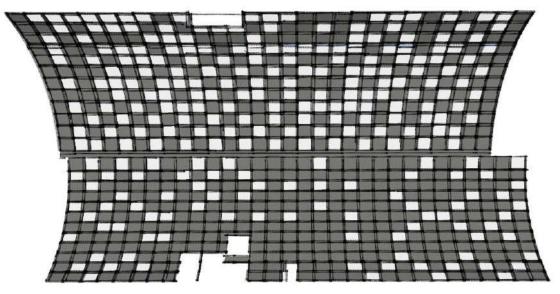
Cubierta vista inferior, espacio para 256 paneles de vidrio de control solar. Fuente: Elaboración propia. (2018).
